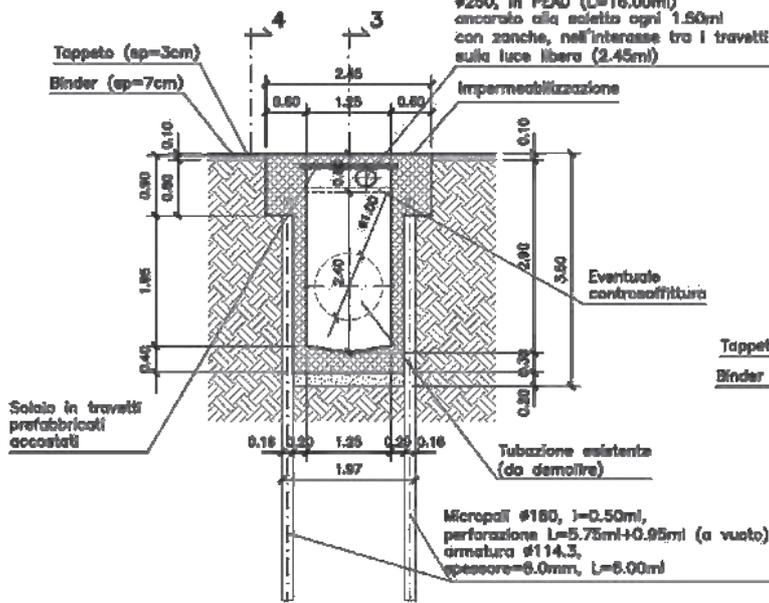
Sezione longitudinale di progetto (secondo lotto)
